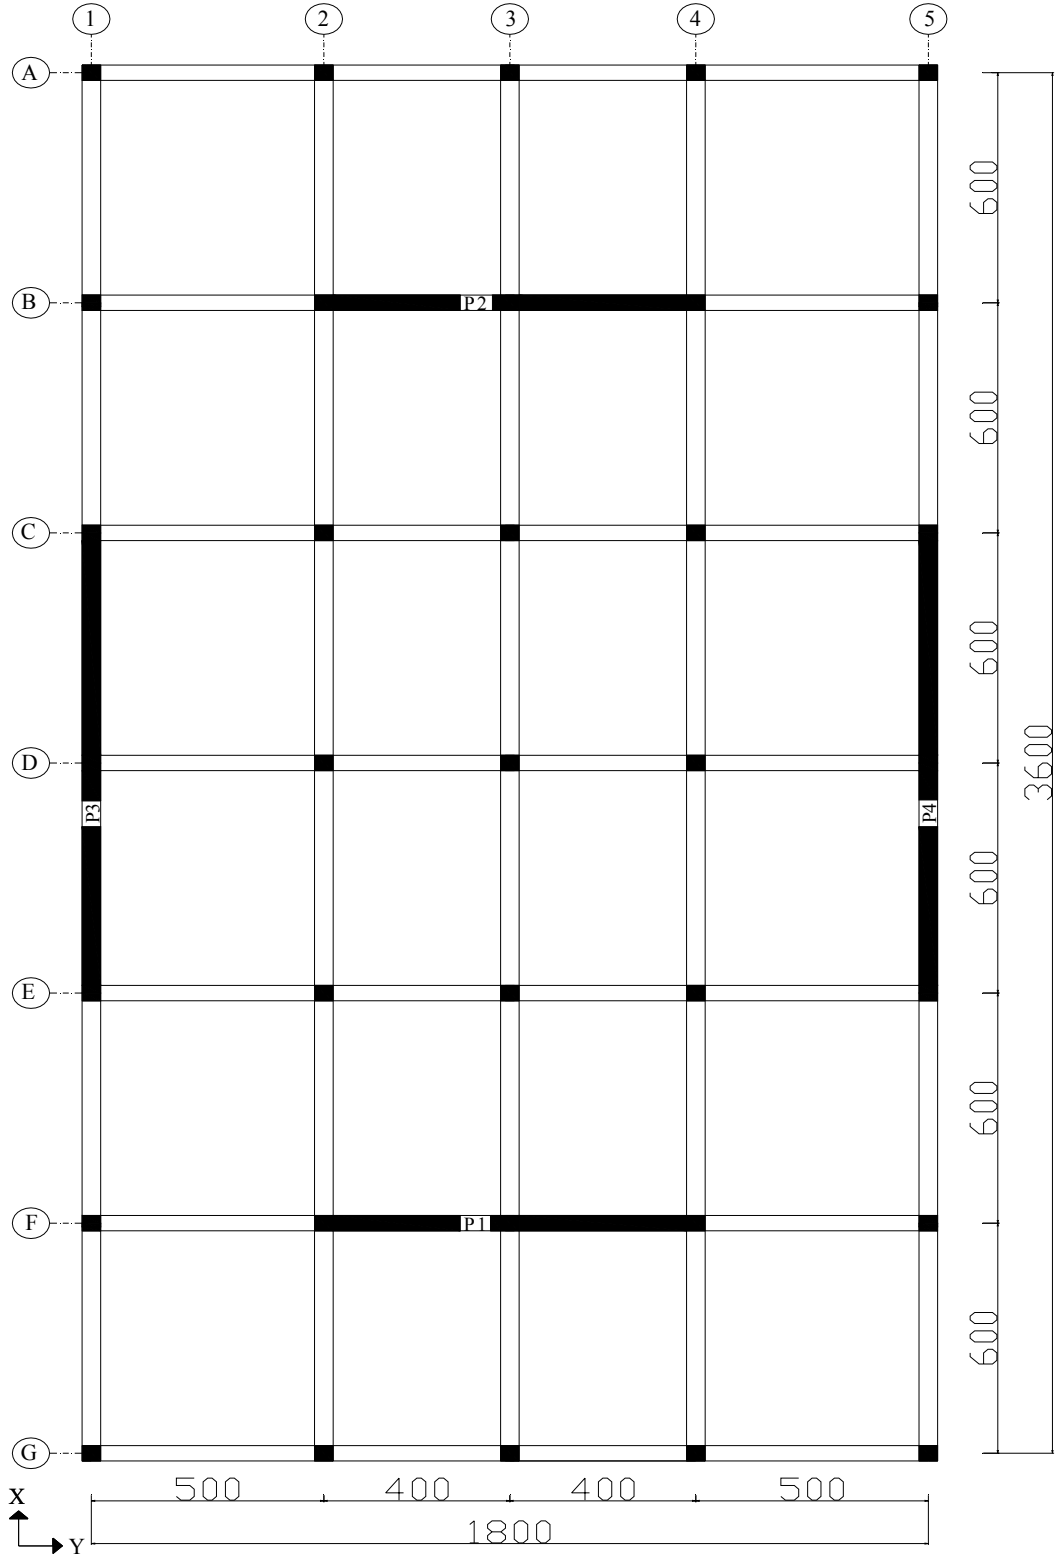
Örnek 5.13'ün kat kalıp planı
